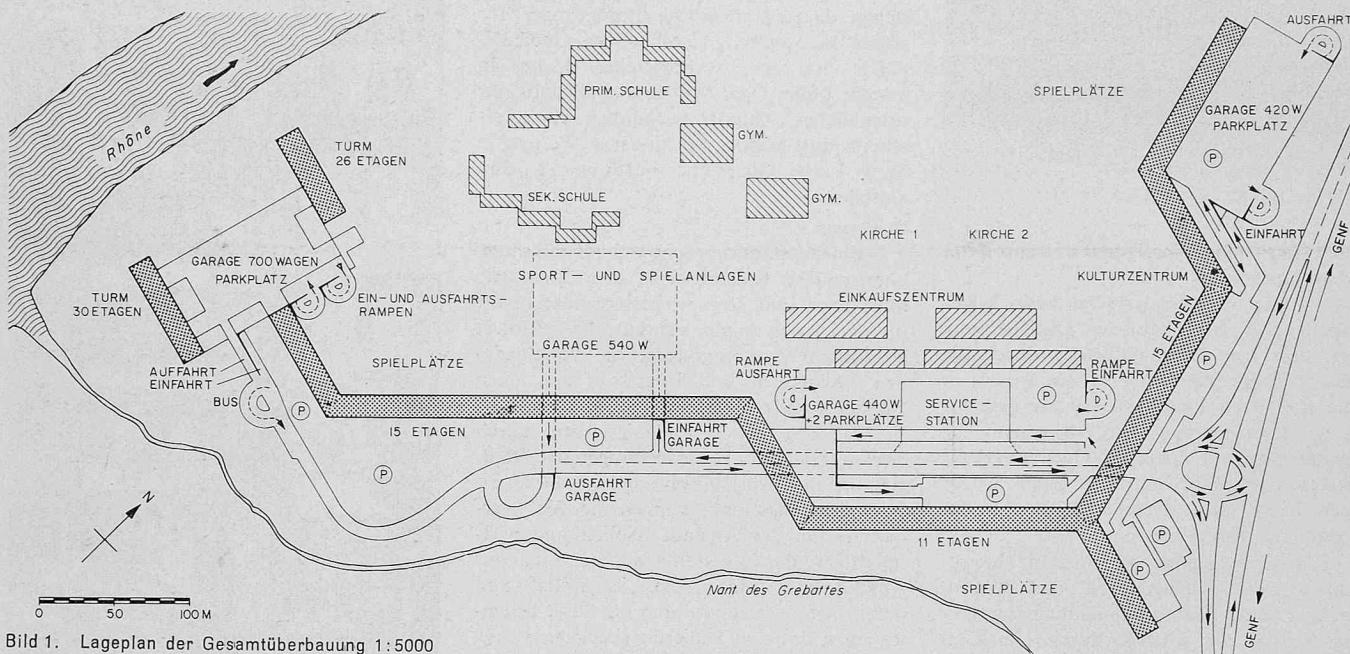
Lageplan der Gesamtüberbauung 1:5000
